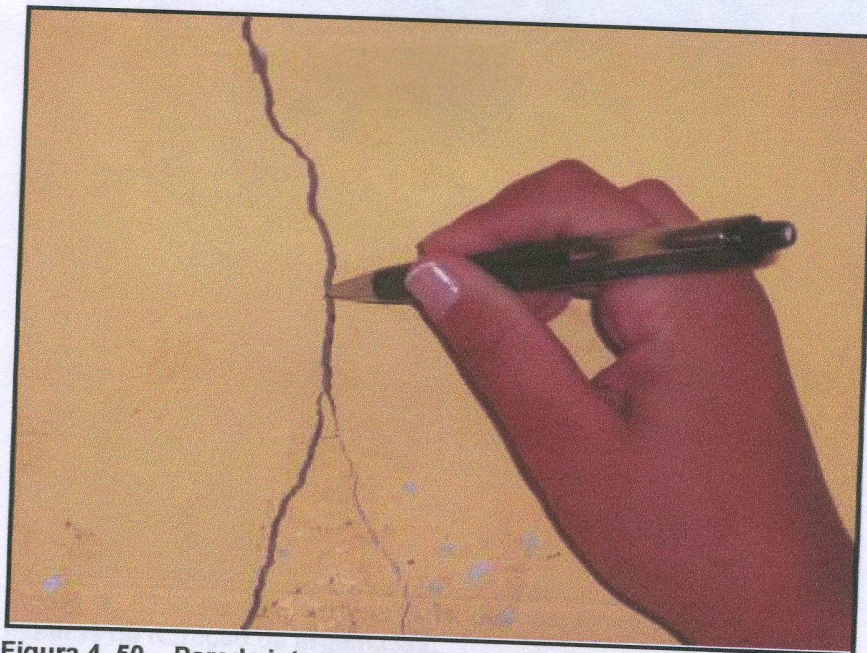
50 – Parede interna com fissura vertical.
